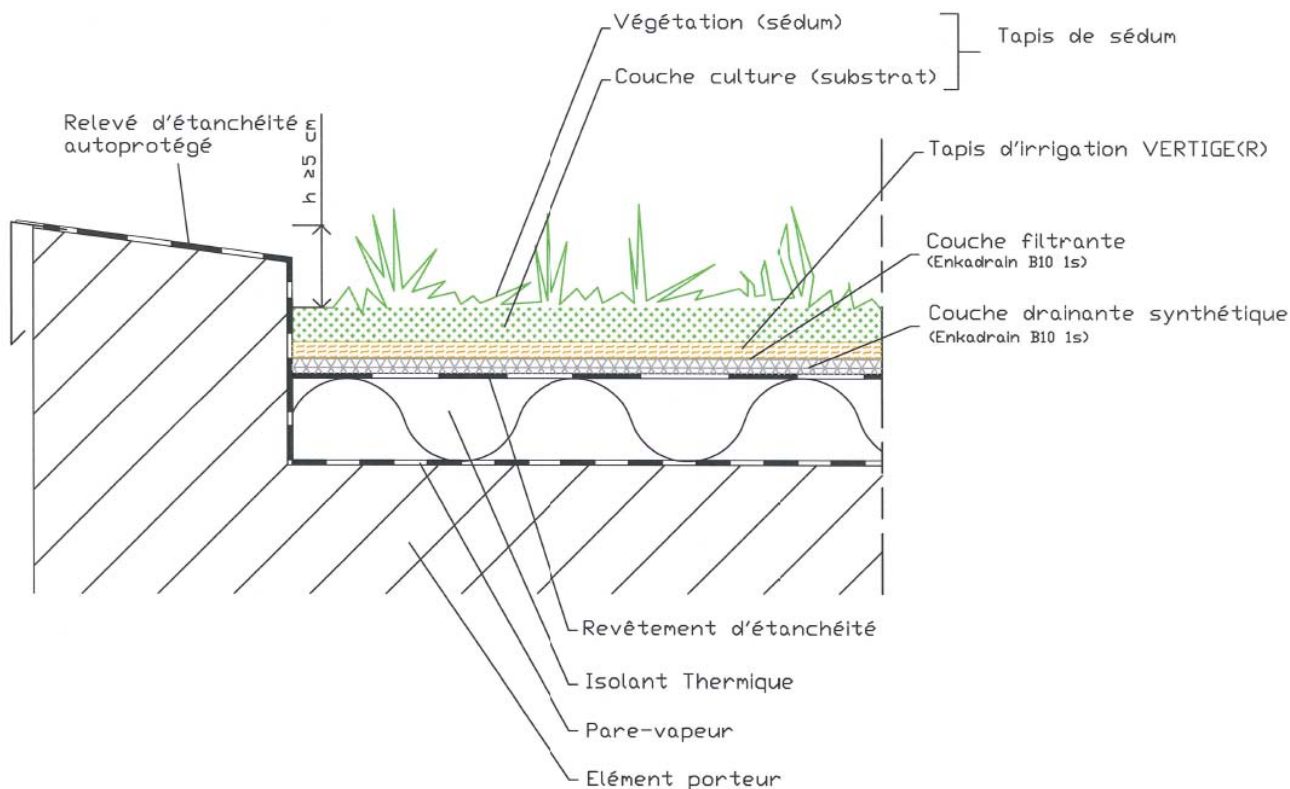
Coupe type sur relevé (sans zone stérile), élément porteur en maçonnerie, de pente comprise entre 2 % et 20 %
